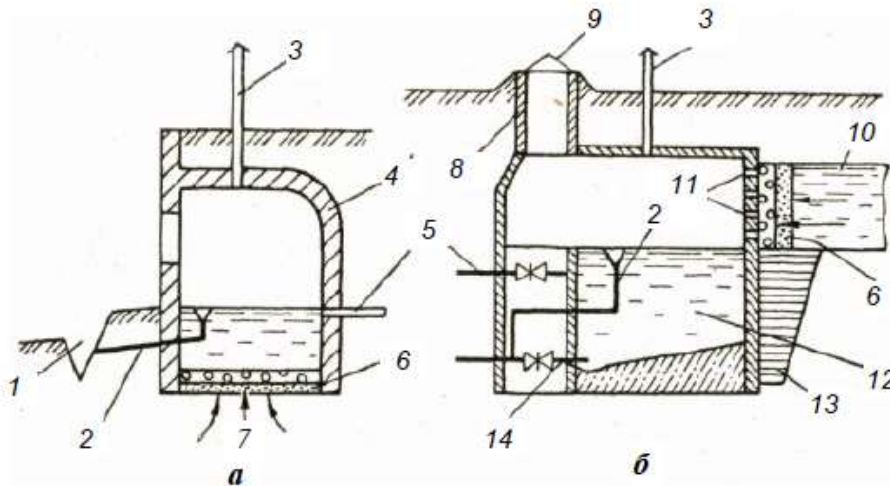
Схеми каптажних камер: а – з висхідного джерела; б – з низхідного джерела; 1 – відвідна канава; 2 – переливна труба; 3 – вентиляційна труба; 4 – каптажна камера; 5 – витратна труба; 6 – зворотний фільтр; 7 – висхідне джерело; 8 – залізобетонні кільця; 9 – чавунний люк; 10 – низхідне джерело; 11 – водоприймальні отвори; 12 – відстійник; 13 – глиняний замок; 14 – труба для скидання бруду
